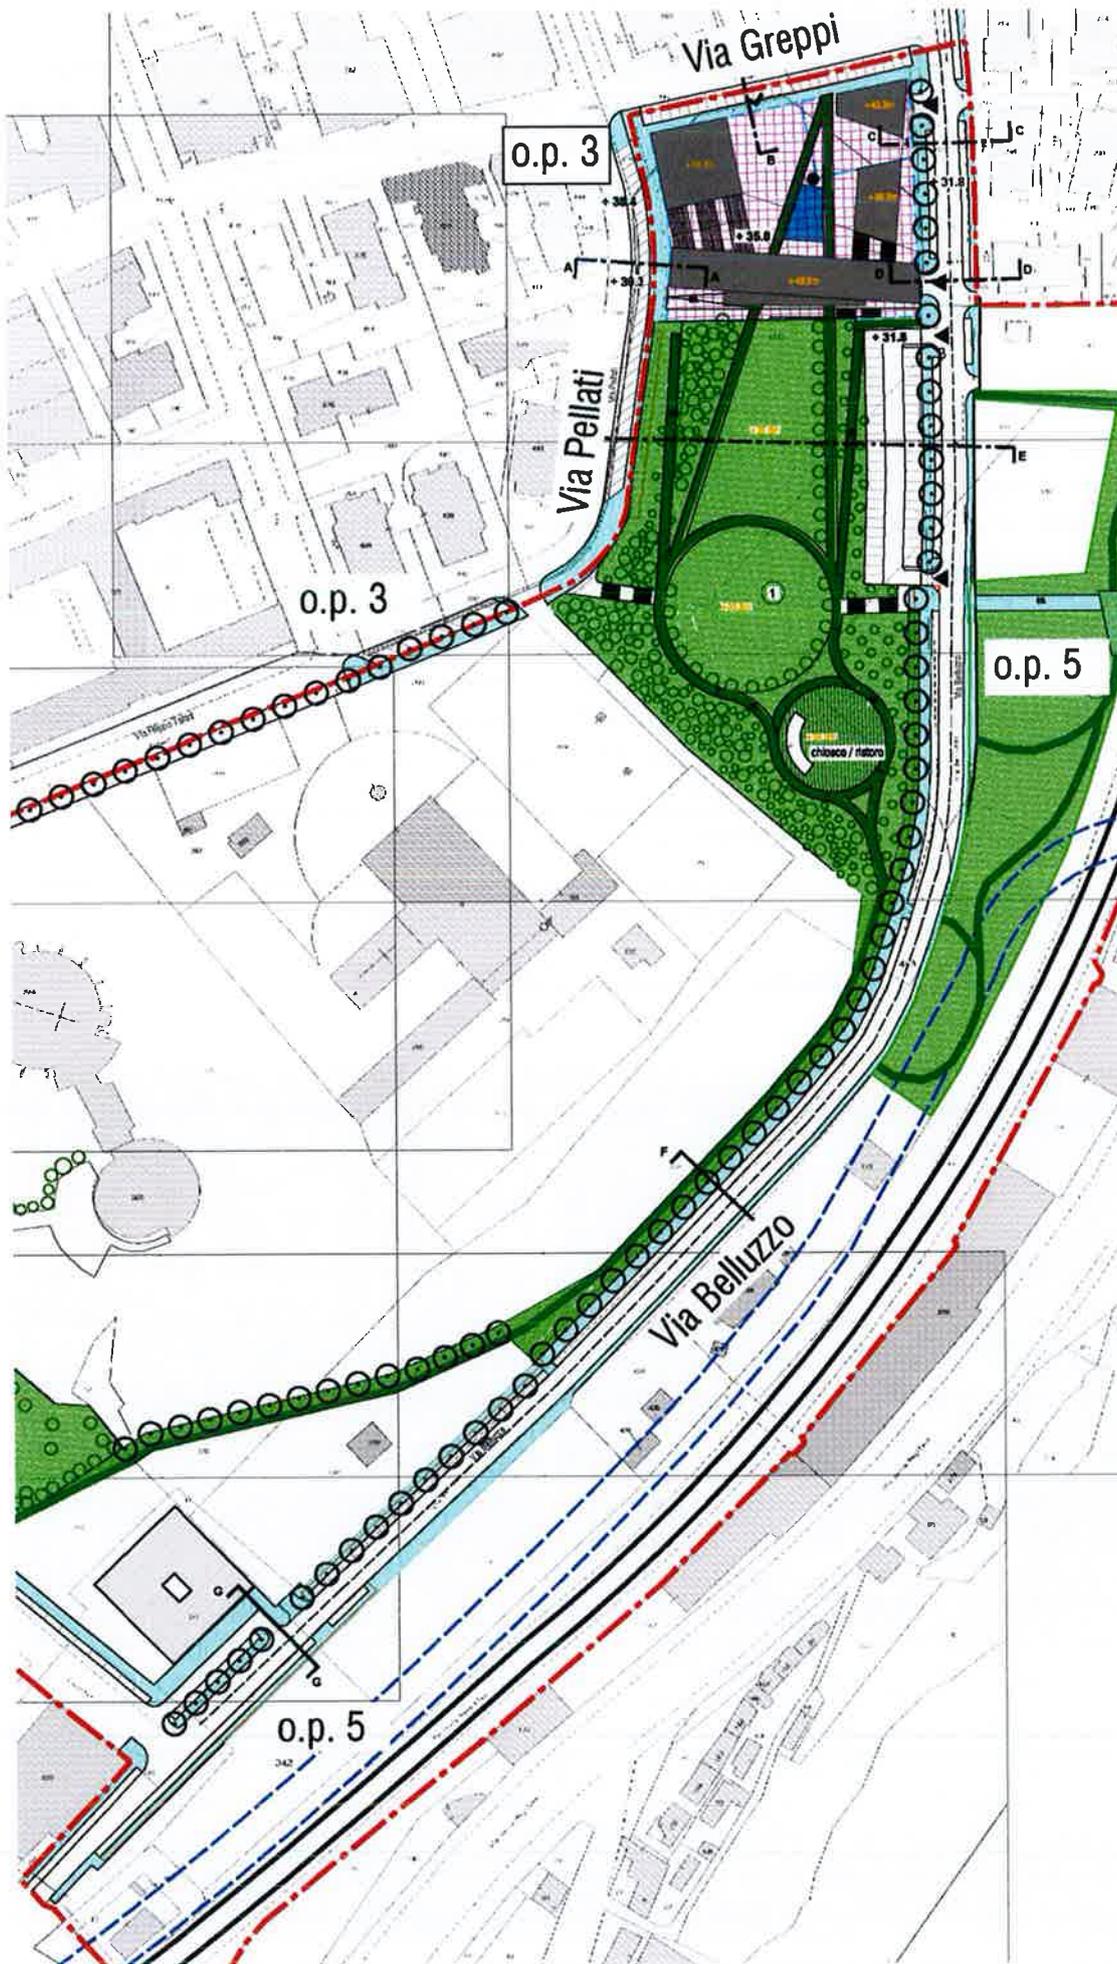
Inquadramento planimetrico dell'opera pubblica n. 5_ scala 1:2000.
